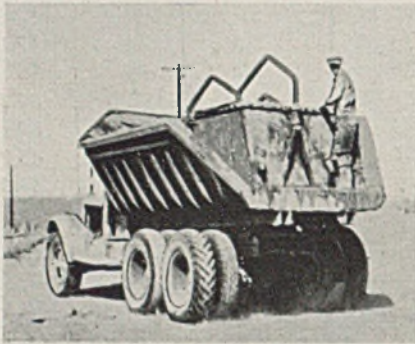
Betontransport mit geländegängigem Fahrzeug.
